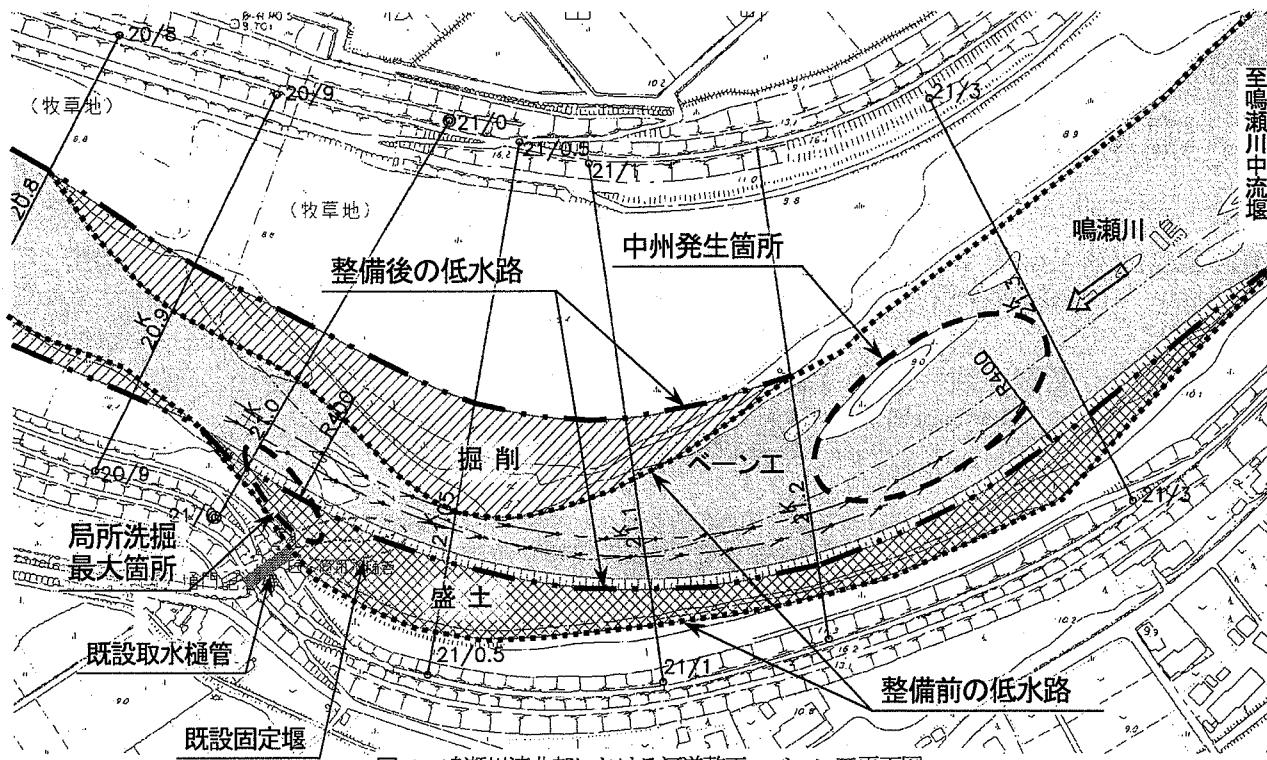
鳴瀬川湾曲部における河道整正、ペーン工平面図
